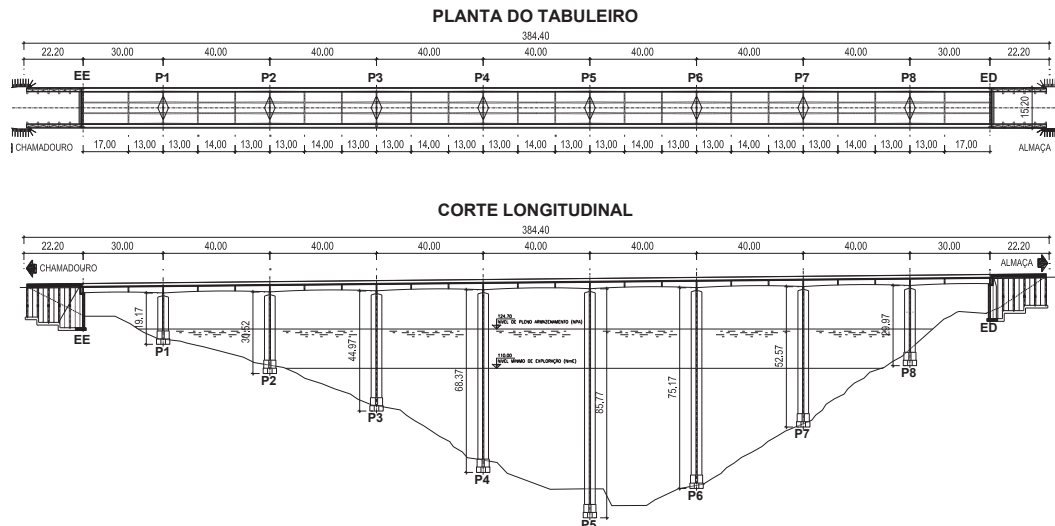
Planta e corte longitudinal da Ponte da Foz do Dão [79]
